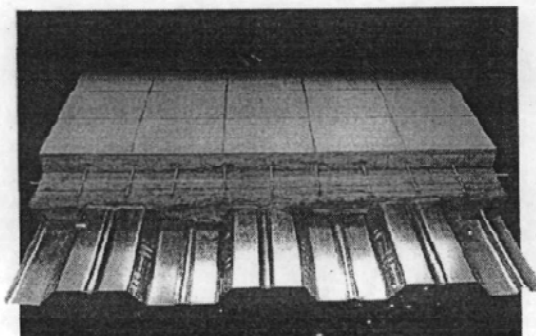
Losa típica construida con lámina de acero y concreto [13]
